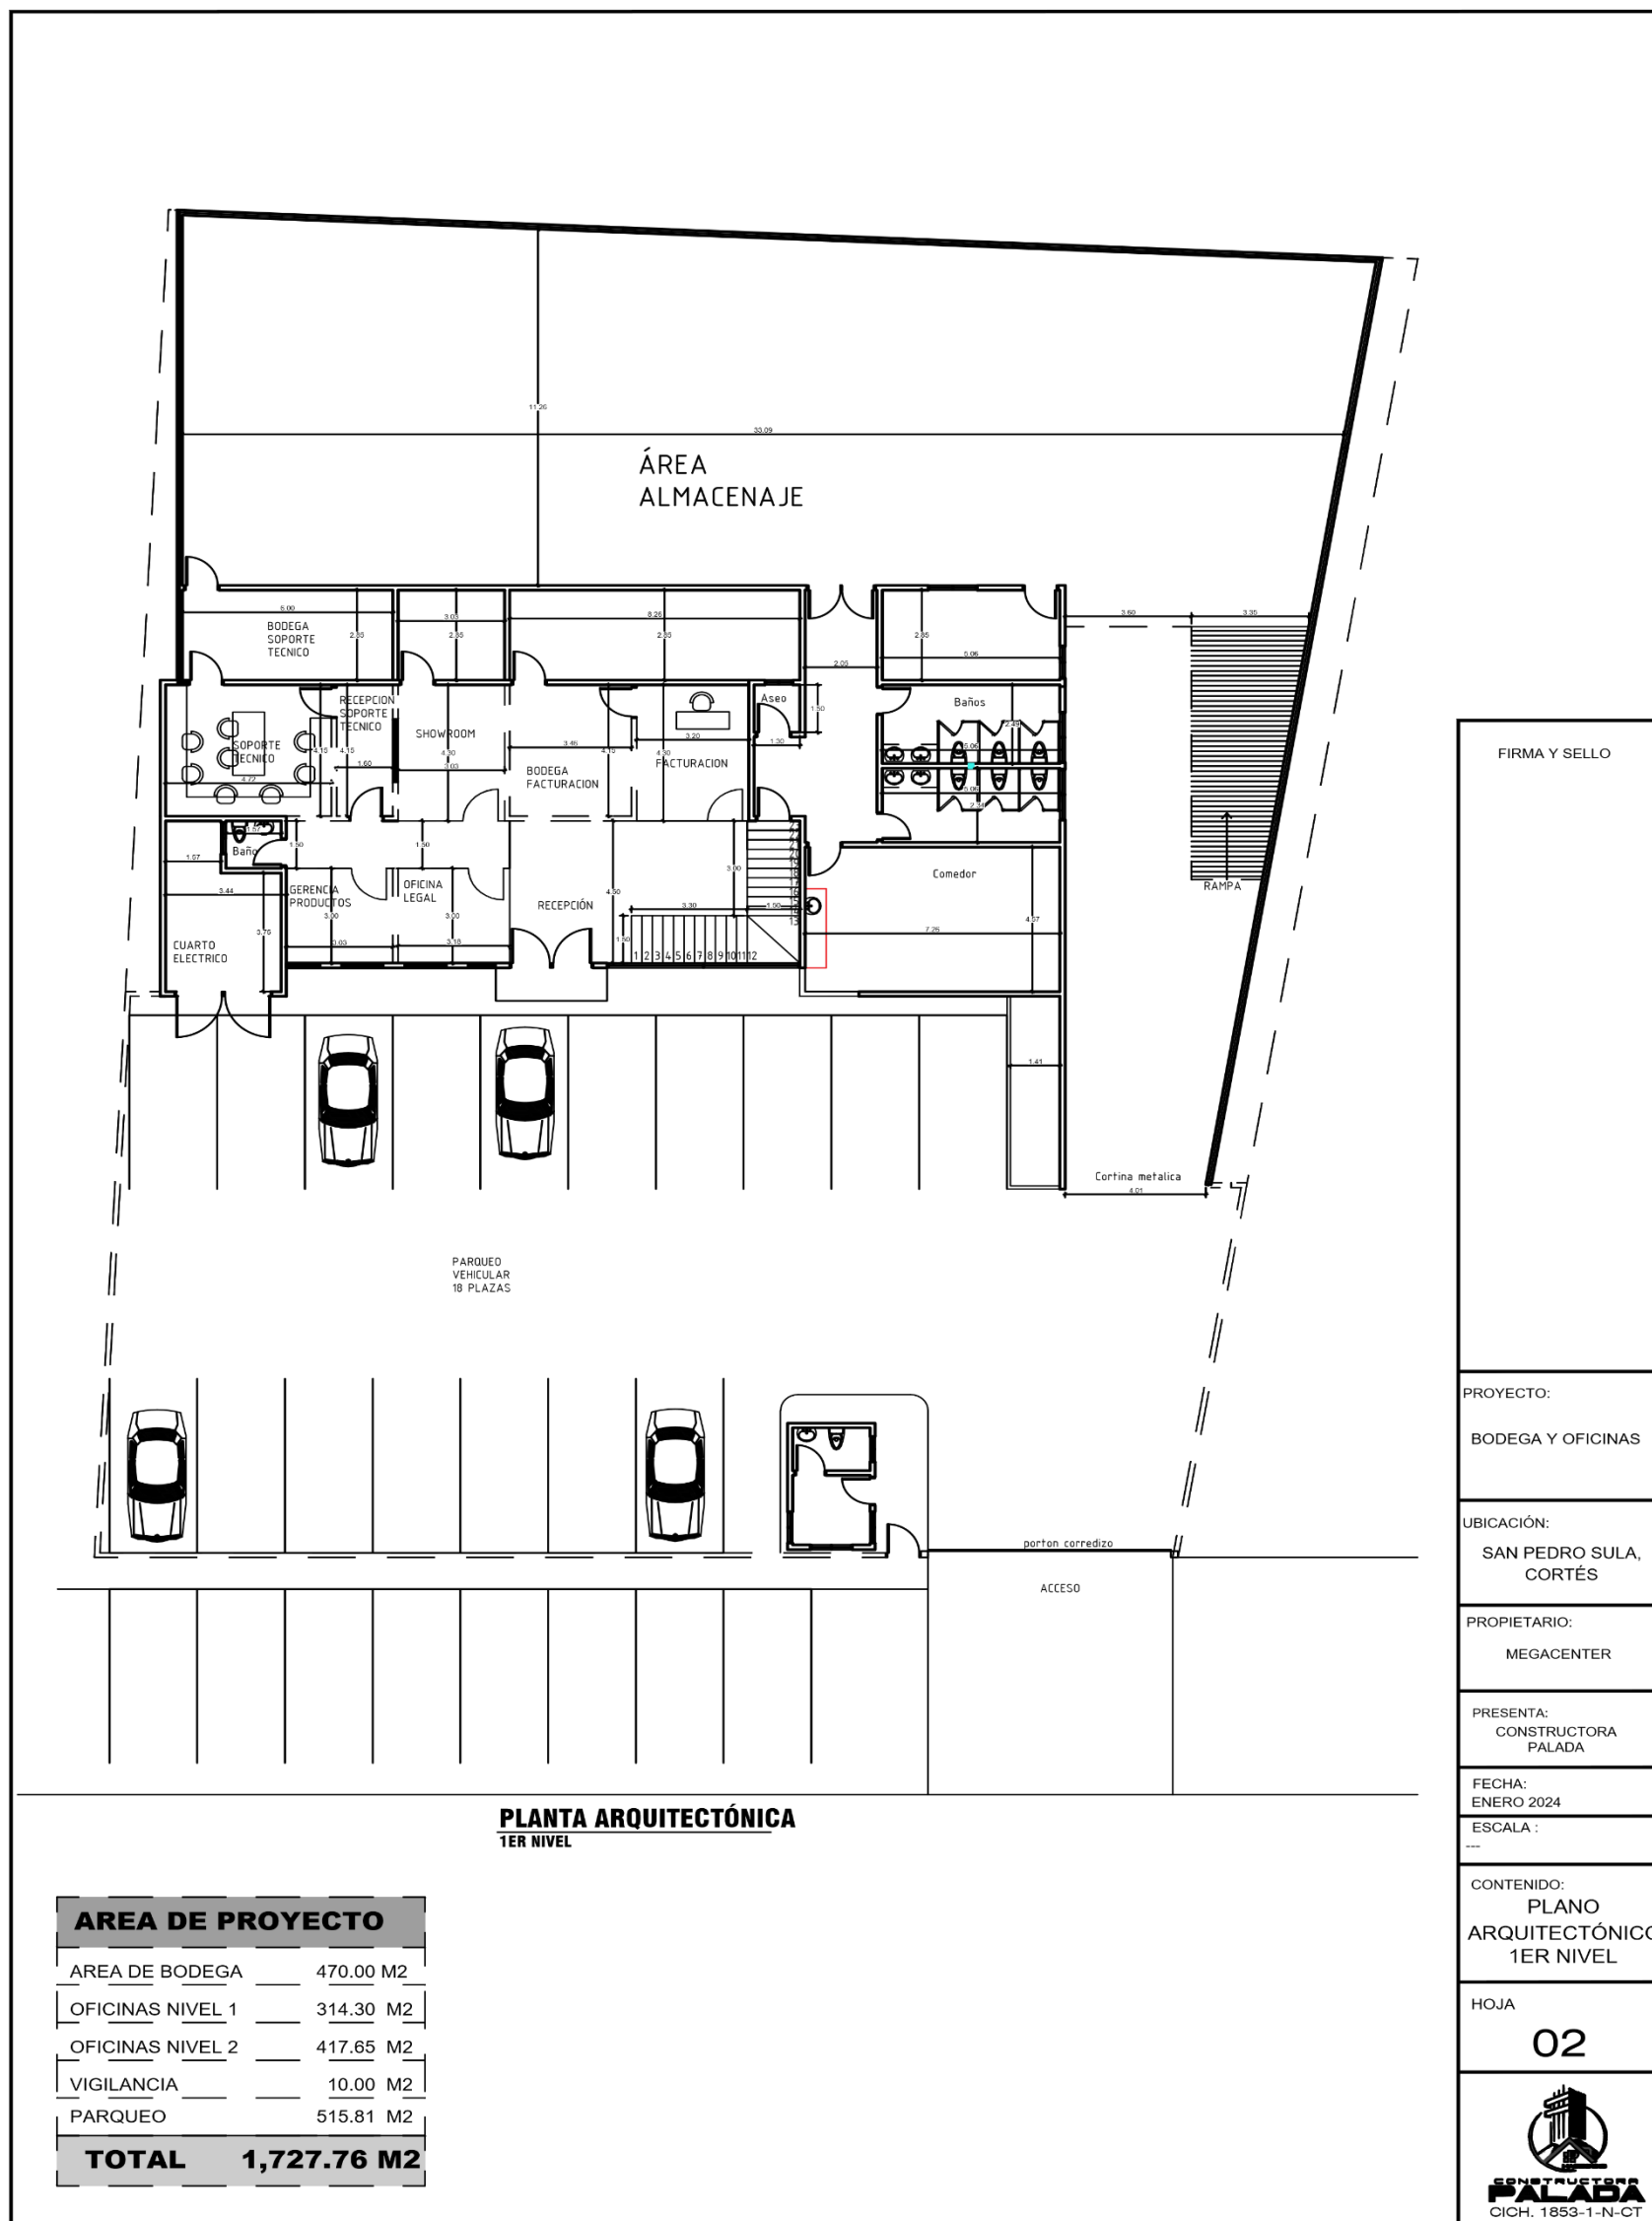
Plano de planta arquitectónico MEGACENTER
